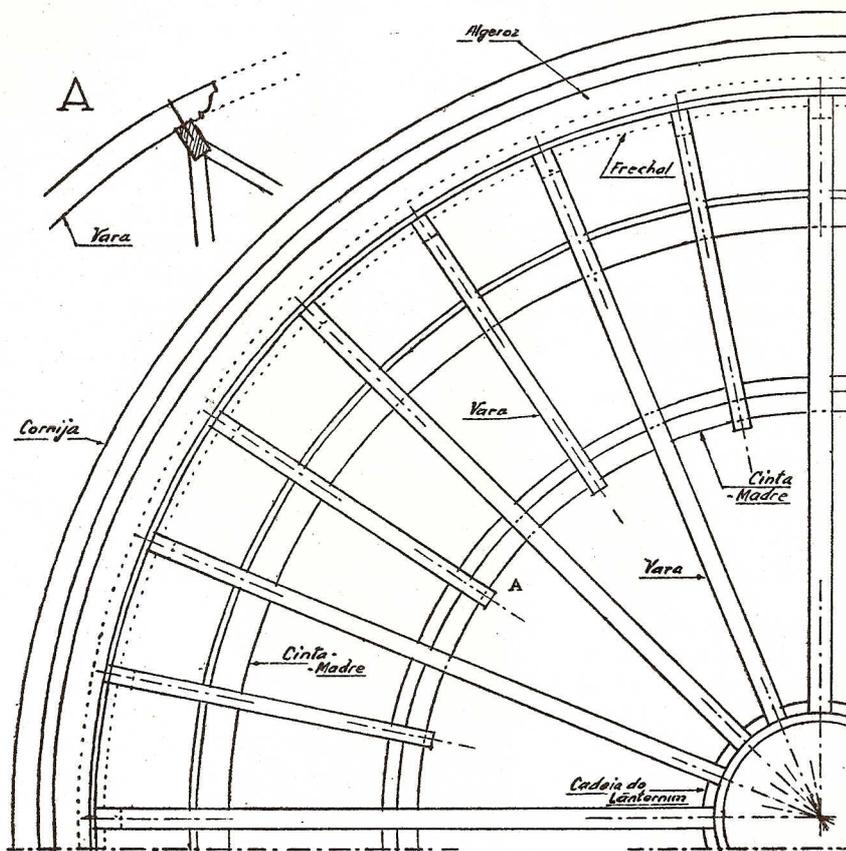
PLANTA DA ESTRUTURA DA CÚPULA ESFÉRICA
